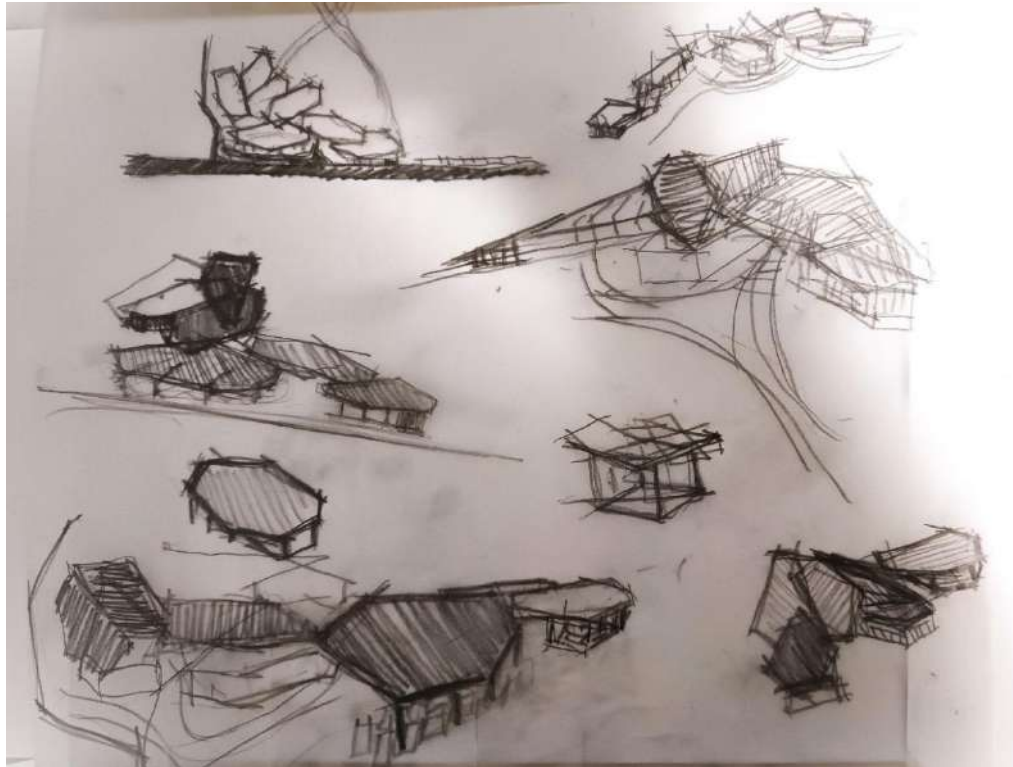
Esquiço da “ligação dos equipamentos arquitetónicos”
